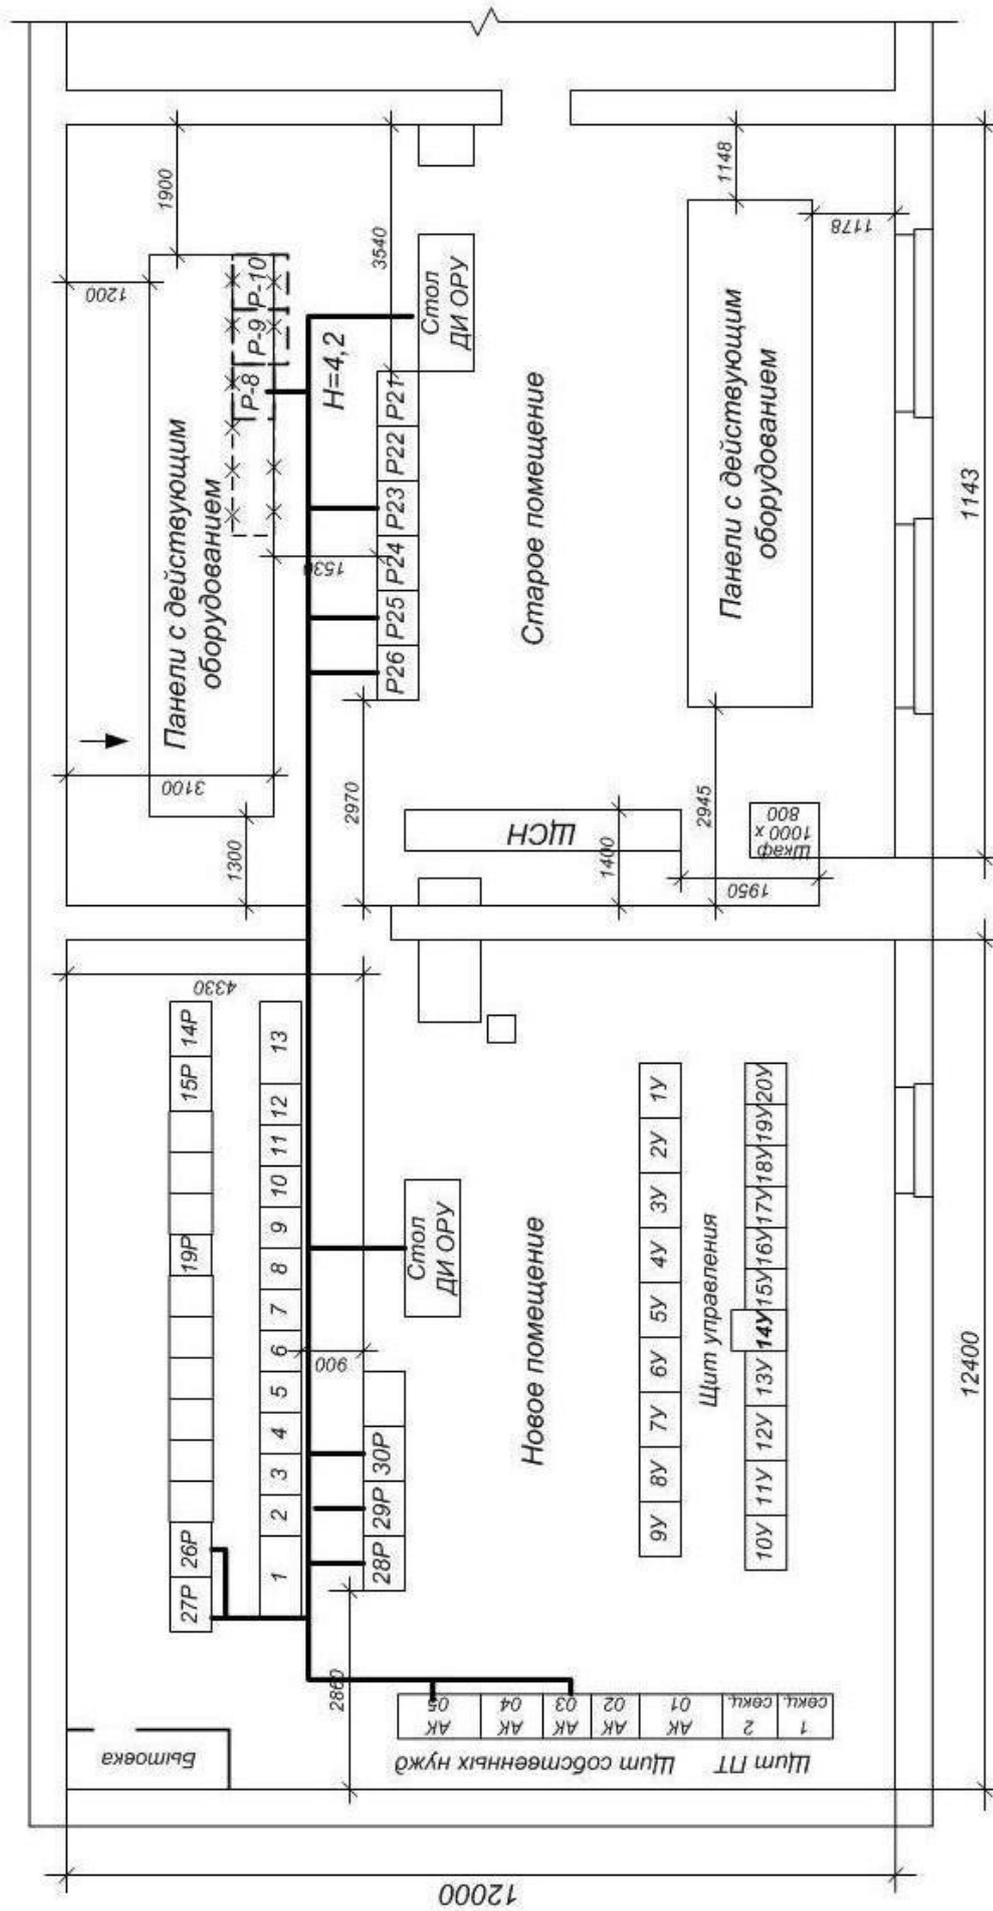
План расположения электроустановок и схема прокладки кабеля
